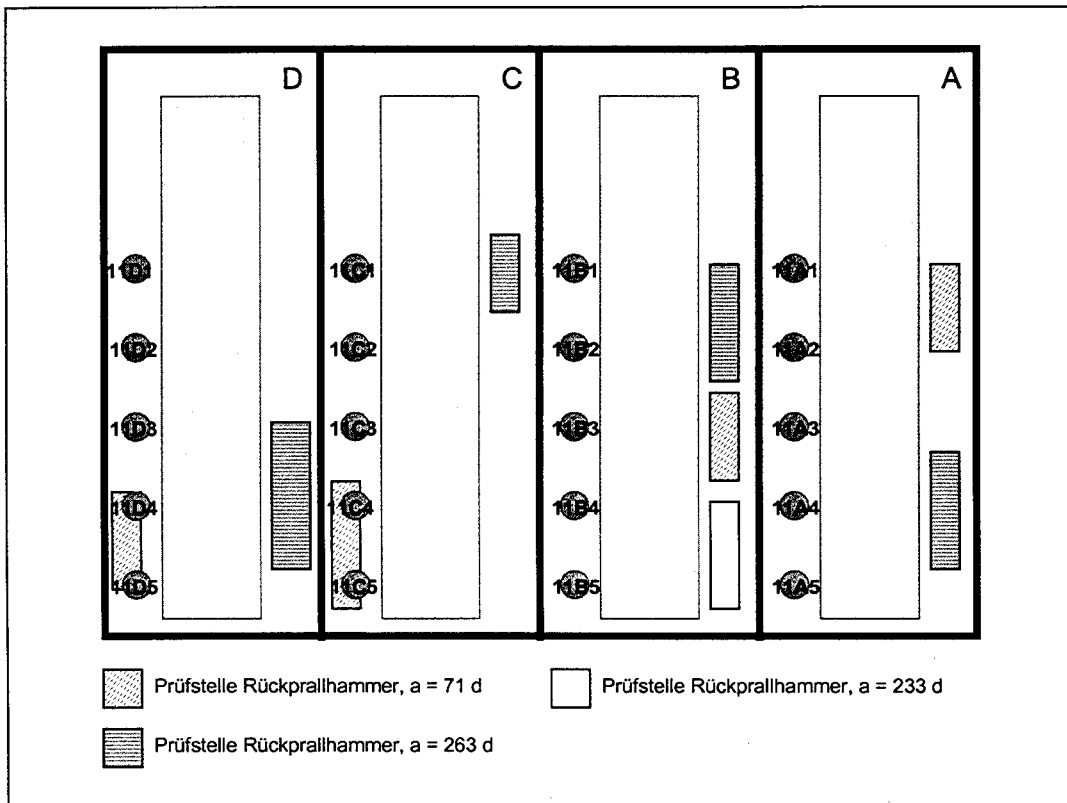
Lage der Prüfflächen am Betonkörper 8
